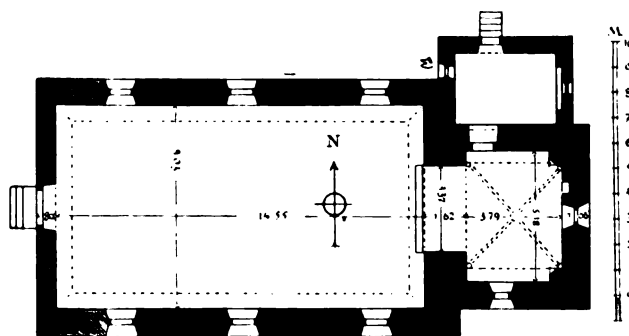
Klafenberg. Grundriß der Pfarrkirche.
